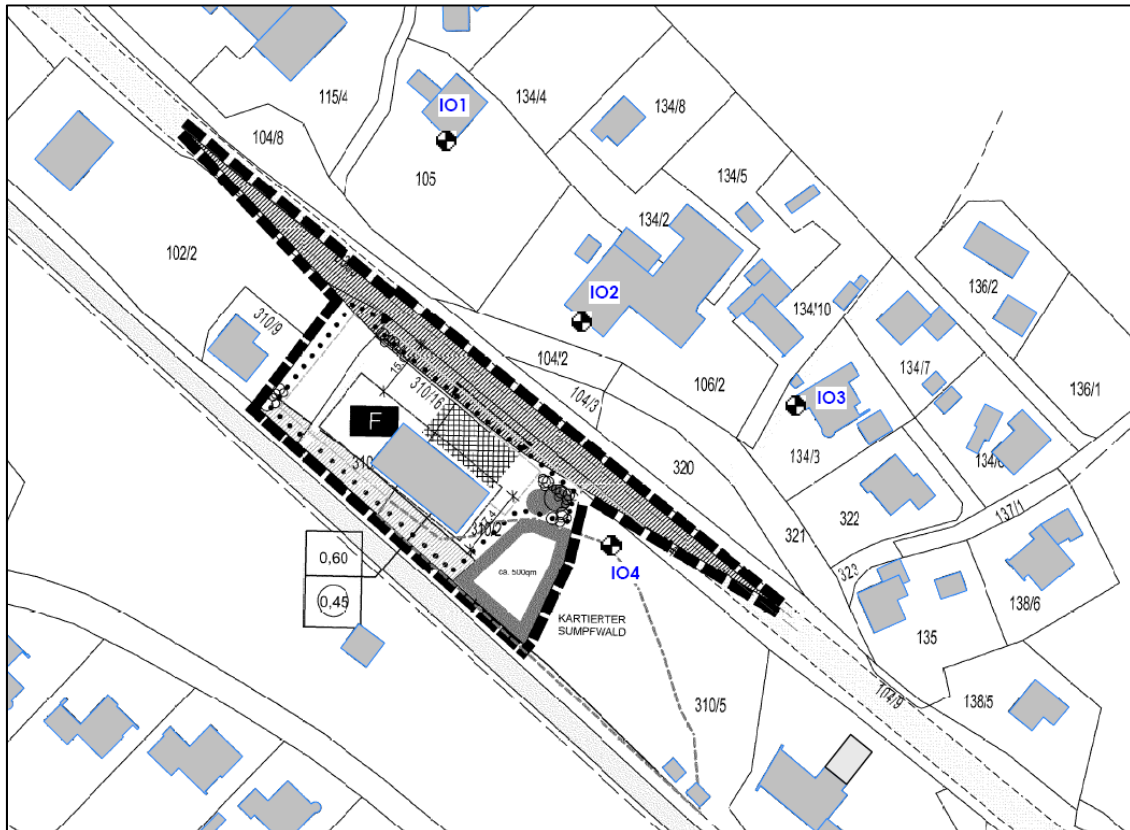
Lageplan mit Darstellung der Immissionsorte (IO)
